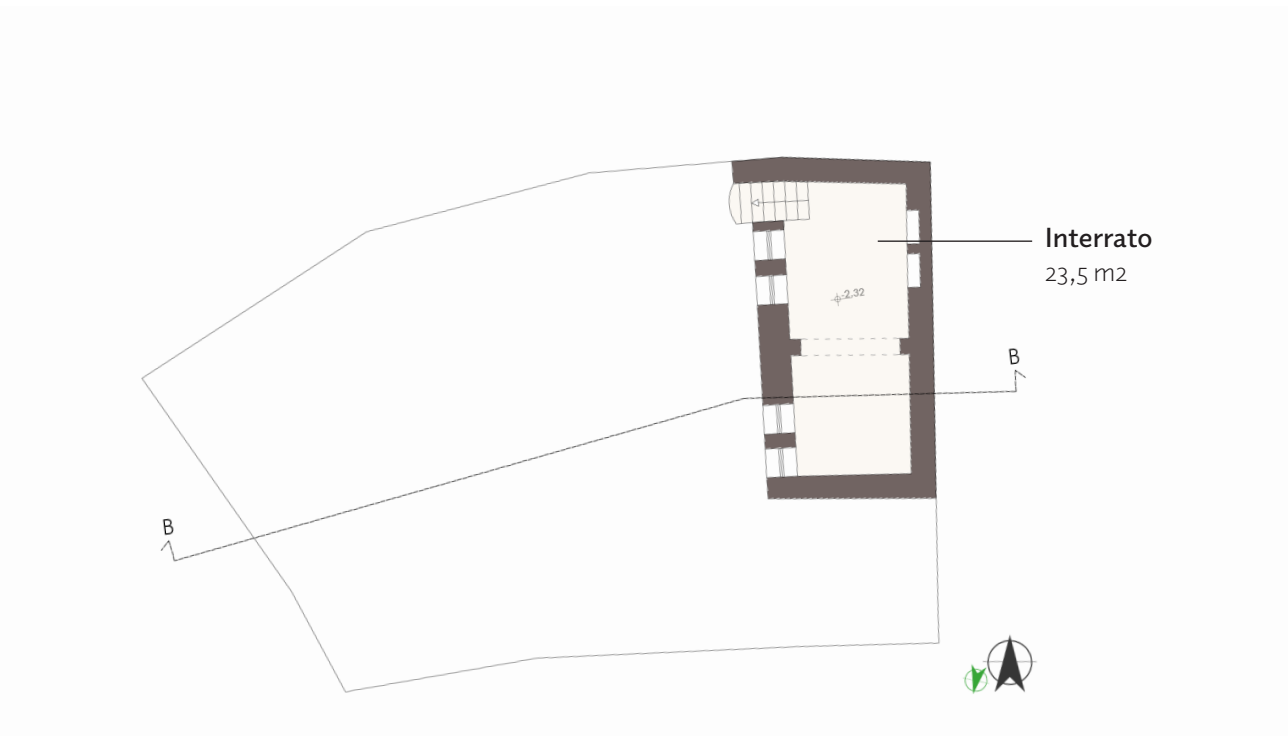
Pianta del piano interrato. Scala 1/200
